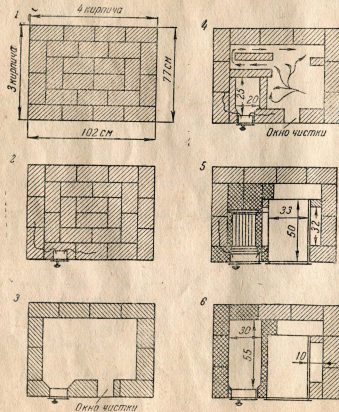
а. Кладка малой шведки трехоборотной с 1-го по 6-й ряд.
